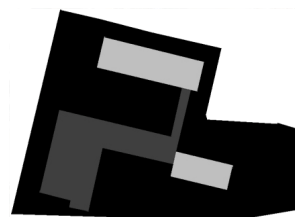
Esquema da planta de implantação da Escola Secundária Pedro de Santarém, em Lisboa.
